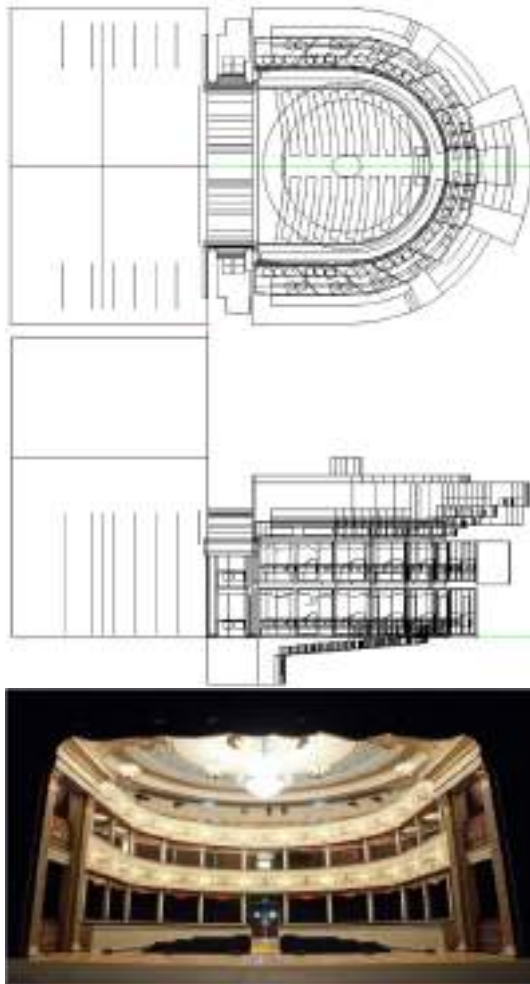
Real Teatro Carlos III de Aranjuez (planta, alzado y vista de sala)
